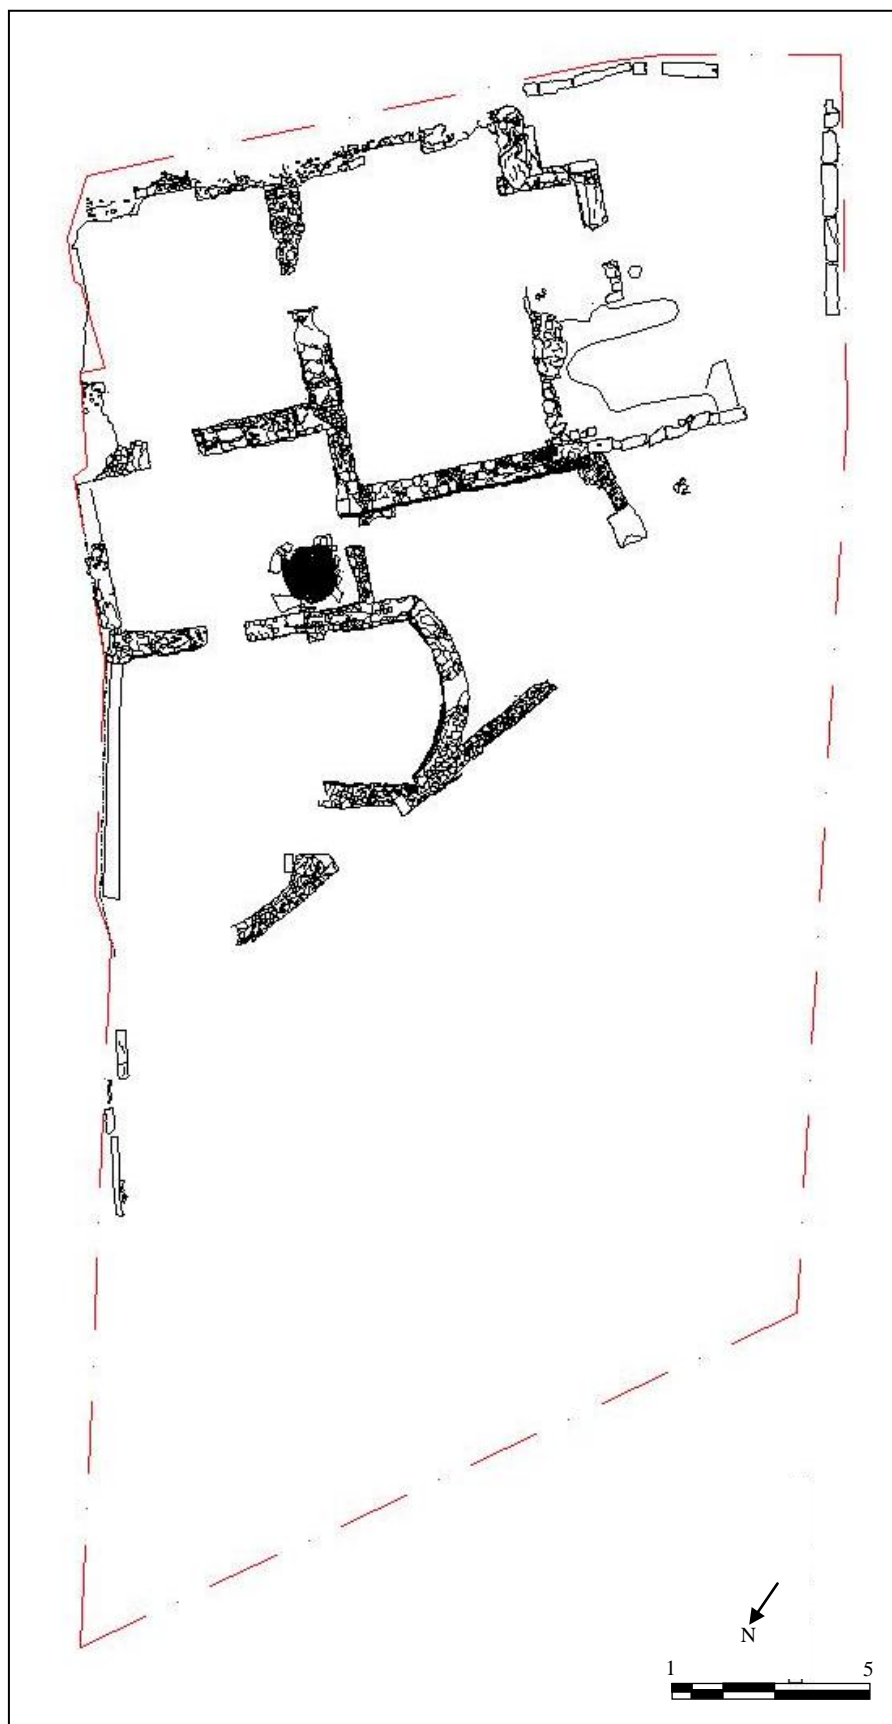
Planimetria ricavata a quota +1.60m con la caratterizzazione delle strutture.
